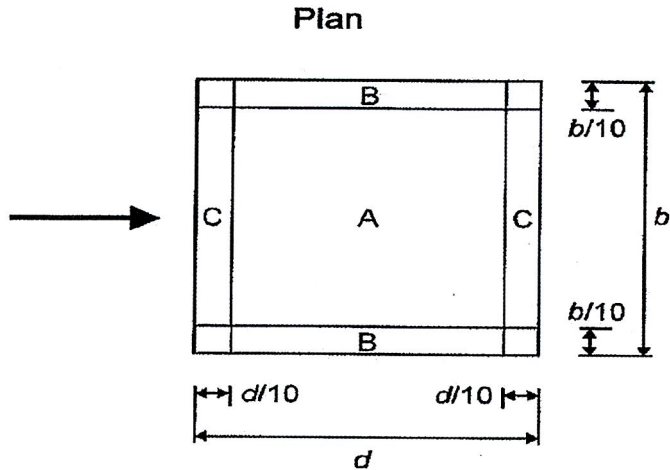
Rysunek przedstawiający przepływ powietrza wokół wiatru
